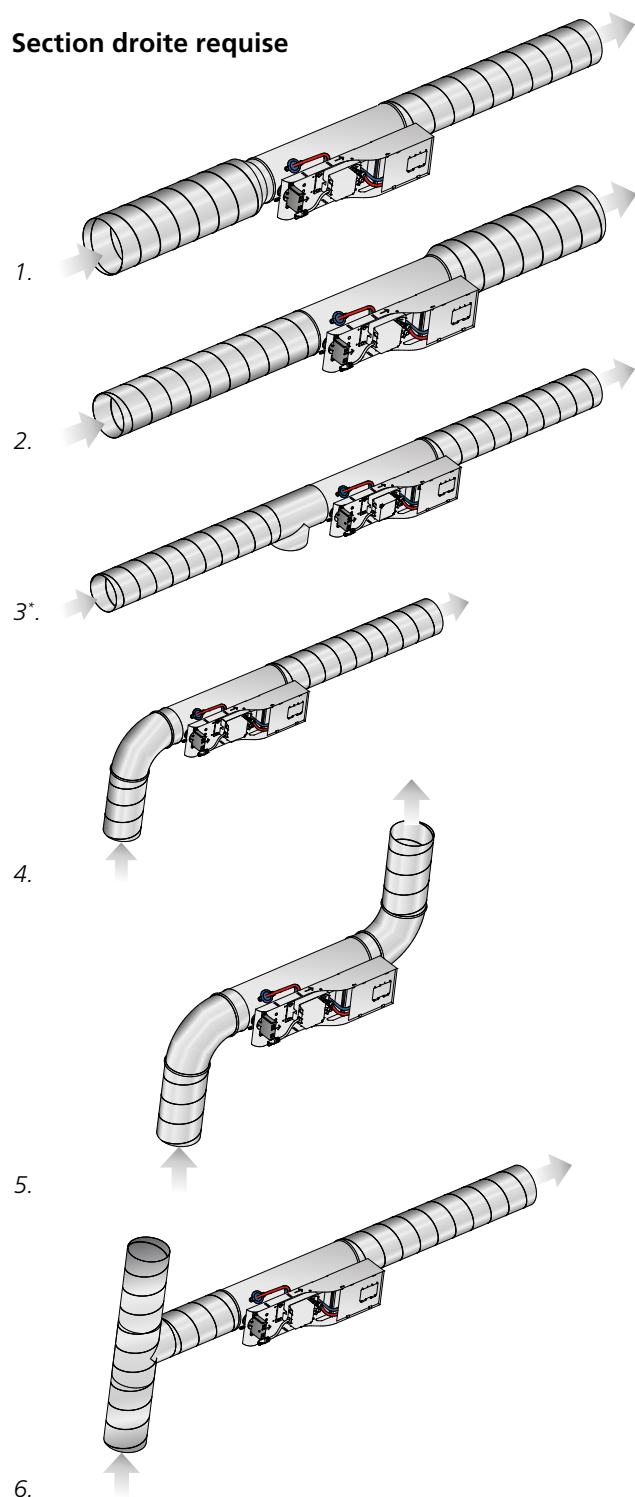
Sections droites requises pour installation sur gaine circulaire.
